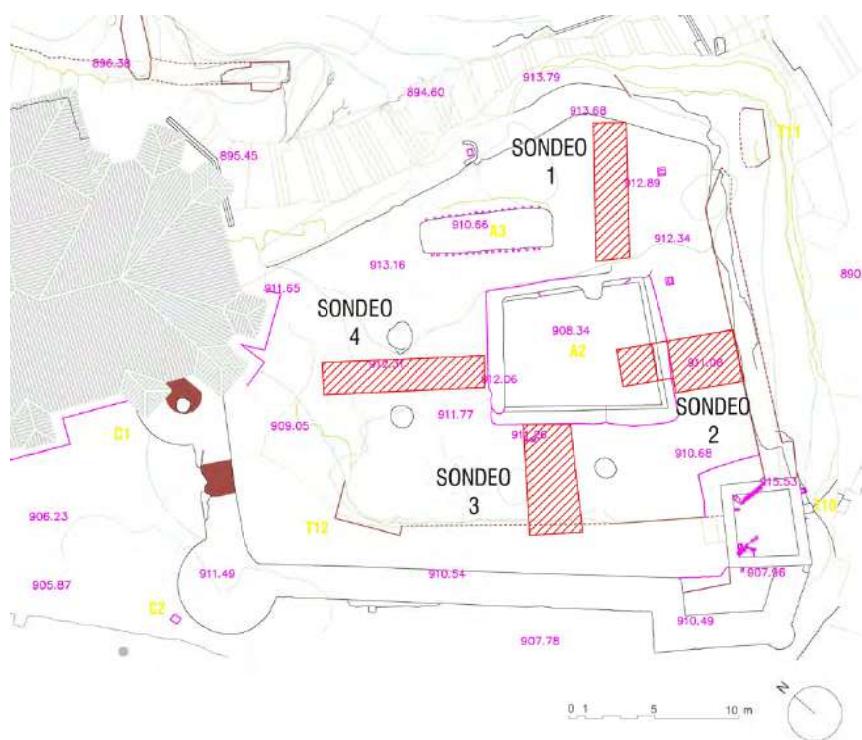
Plano de los sondeos realizados en la primera campaña.
